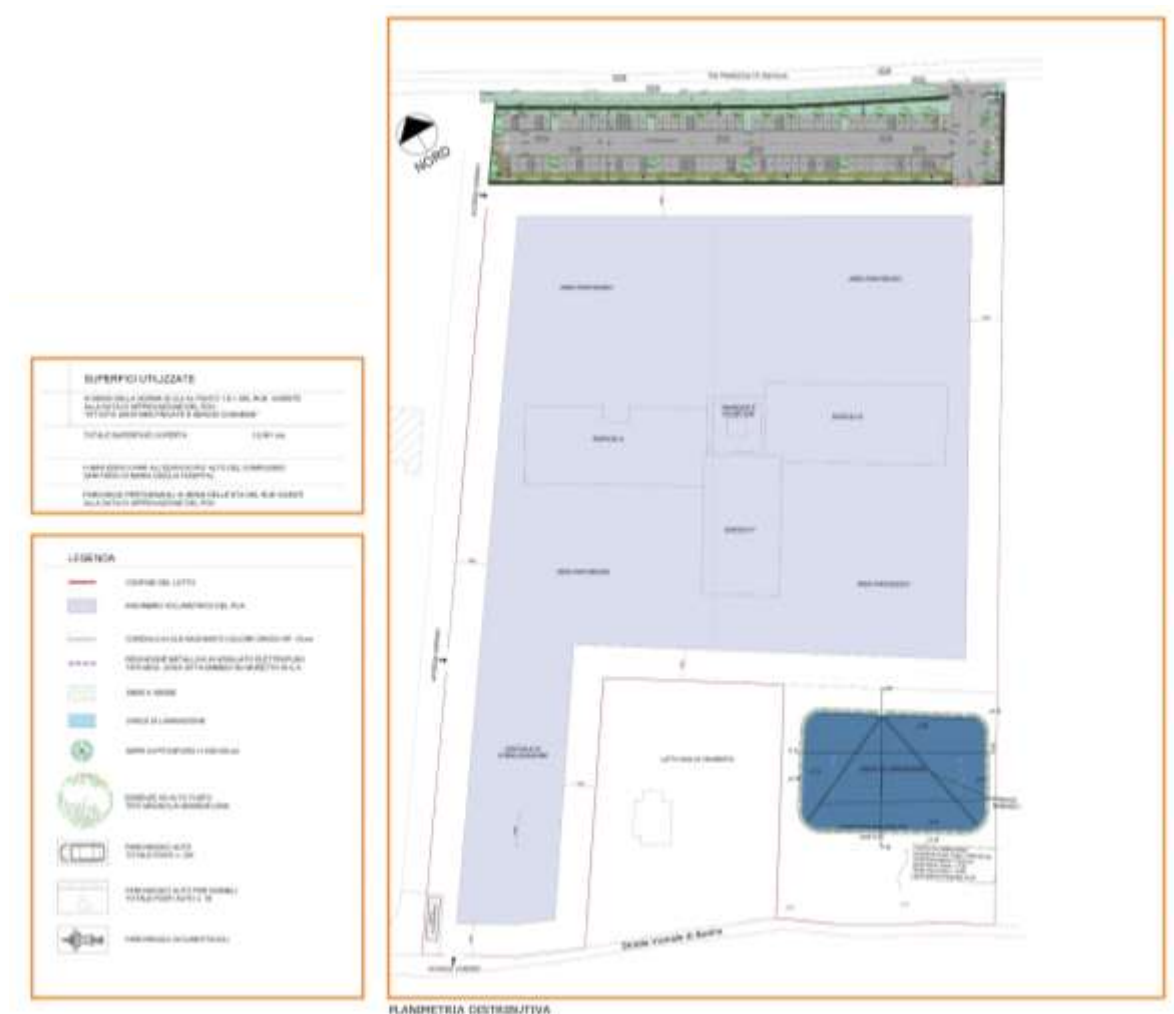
Stralcio planimetrico del PUA di VARIANTE
